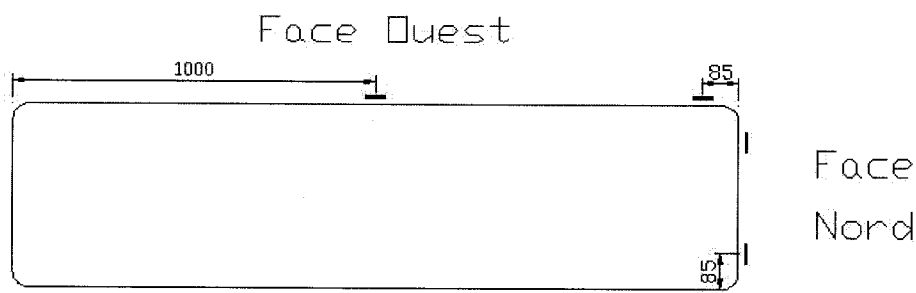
Schéma de l'emplacement des jauges sur le renforcement en composite des spécimens 3 et 4
